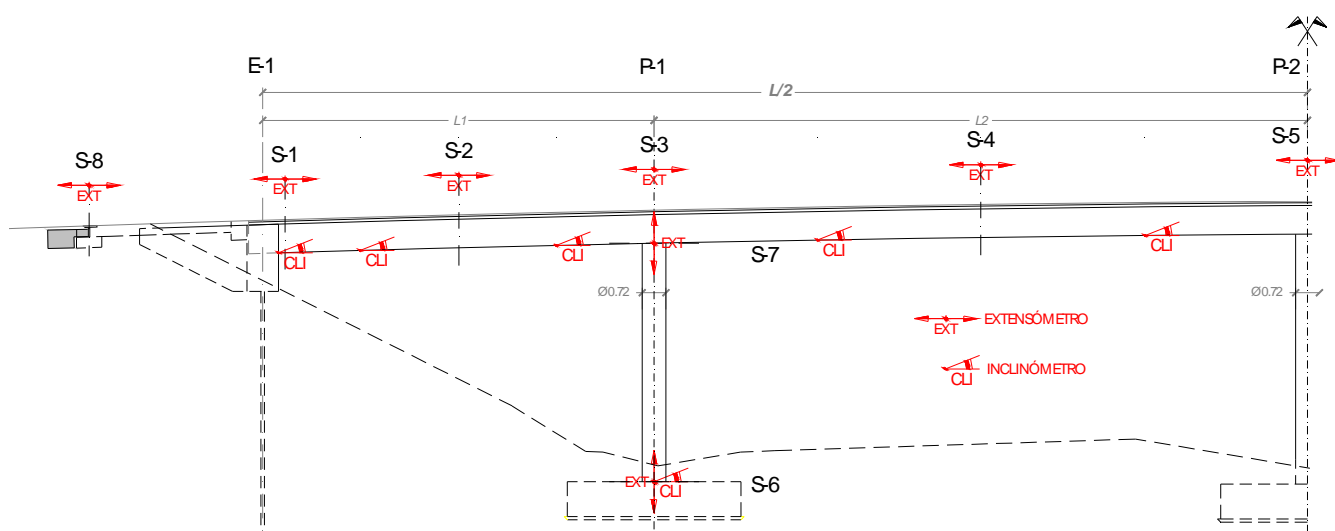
Esquema de instrumentación. Vista Lateral de la mitad instrumentada del puente.
